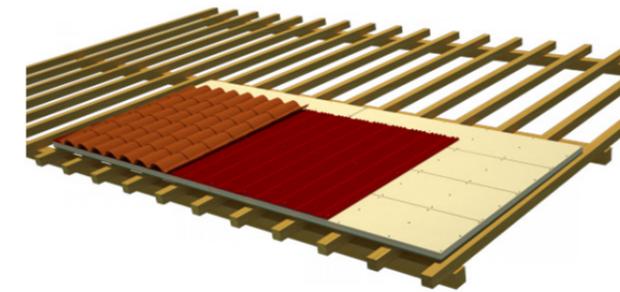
Sistema constructivo ONDUTHERM BASIC (Web Onduline)
